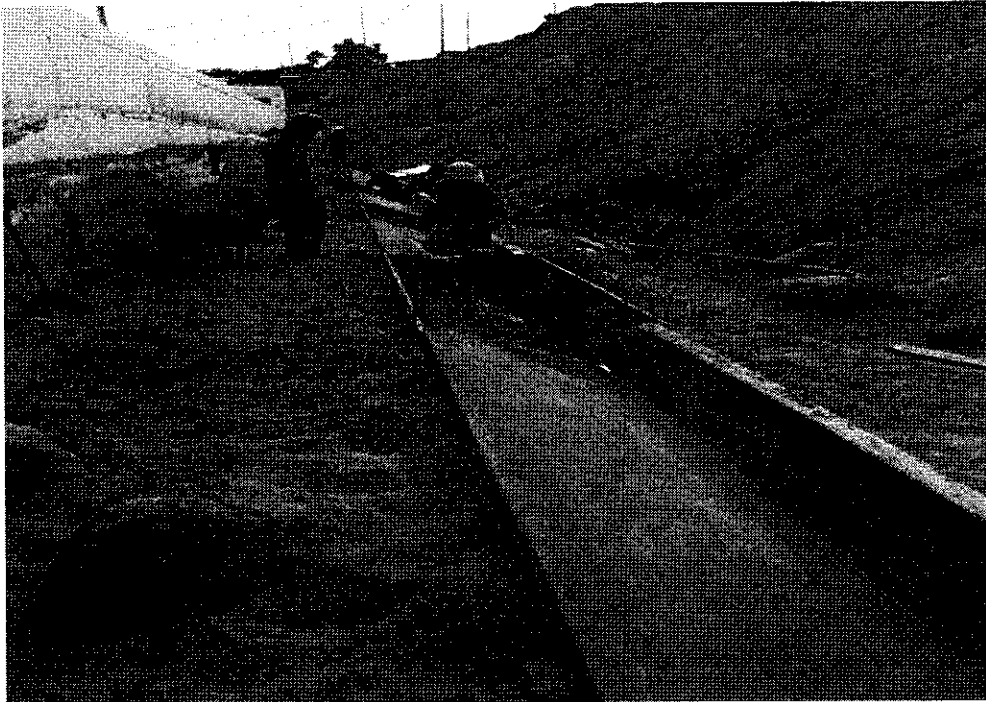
CONCRETO EN CUNETAS A PIE DE TALUD.
